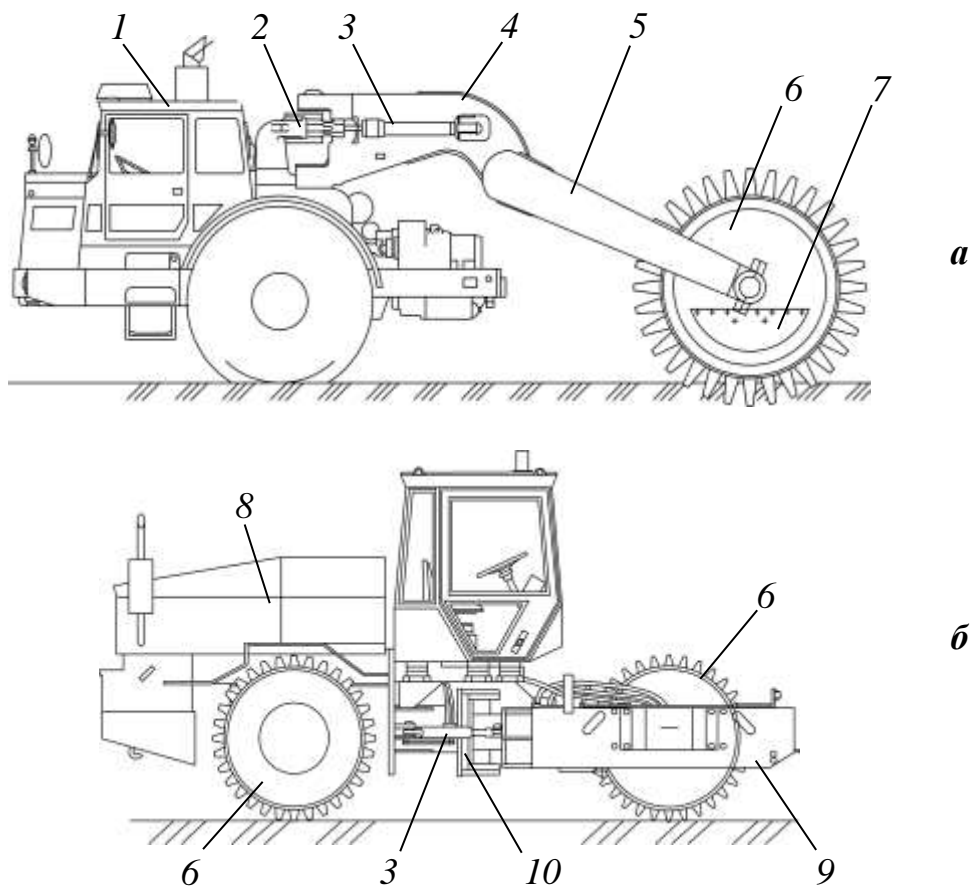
Котки статичної дії з кулачковими металевими вальцями: а – напівпричіпний; б – самохідний; 1 – одновісний тягач; 2 – зчіпний пристрій; 3 – гідроциліндр повороту; 4 – дишло; 5 – рама; 6 – кулачковий валець; 7 – люк для баласту; 8 – силовий модуль; 9 – напіврама; 10 – шарнірне з'єднання
